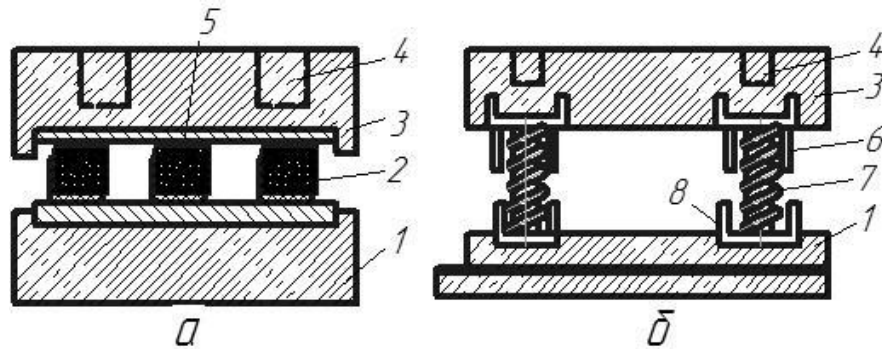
Віброізоляційні фундаменти на гумових (а) та пружних амортизаторах (б): 1, 3 – залізобетонні плити; 2 – гумові пластини; 4 - колодці для болтів; 5 – антисептовані дошки; 6 – верхній стакан; 7 – пружина; 8 – нижній стакан
